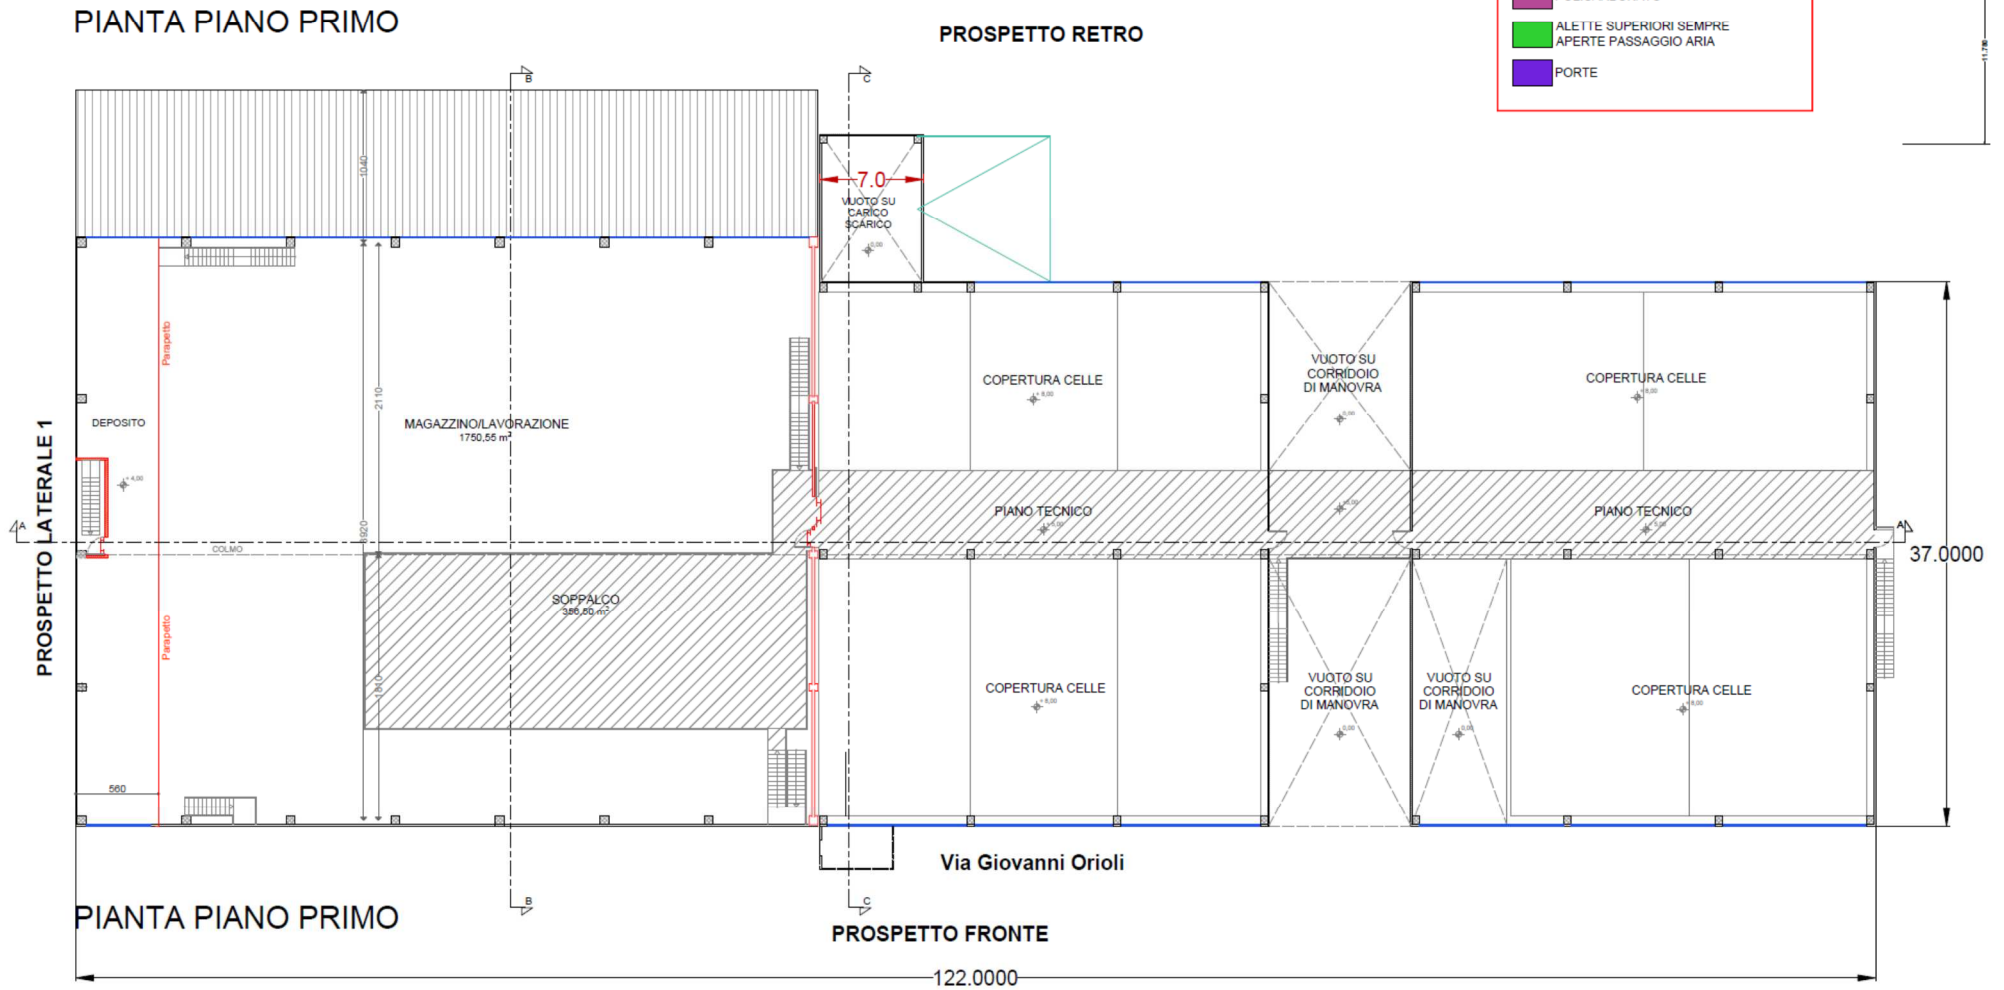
Tavola 1: Elaborato di progetto – Pianta piano primo
